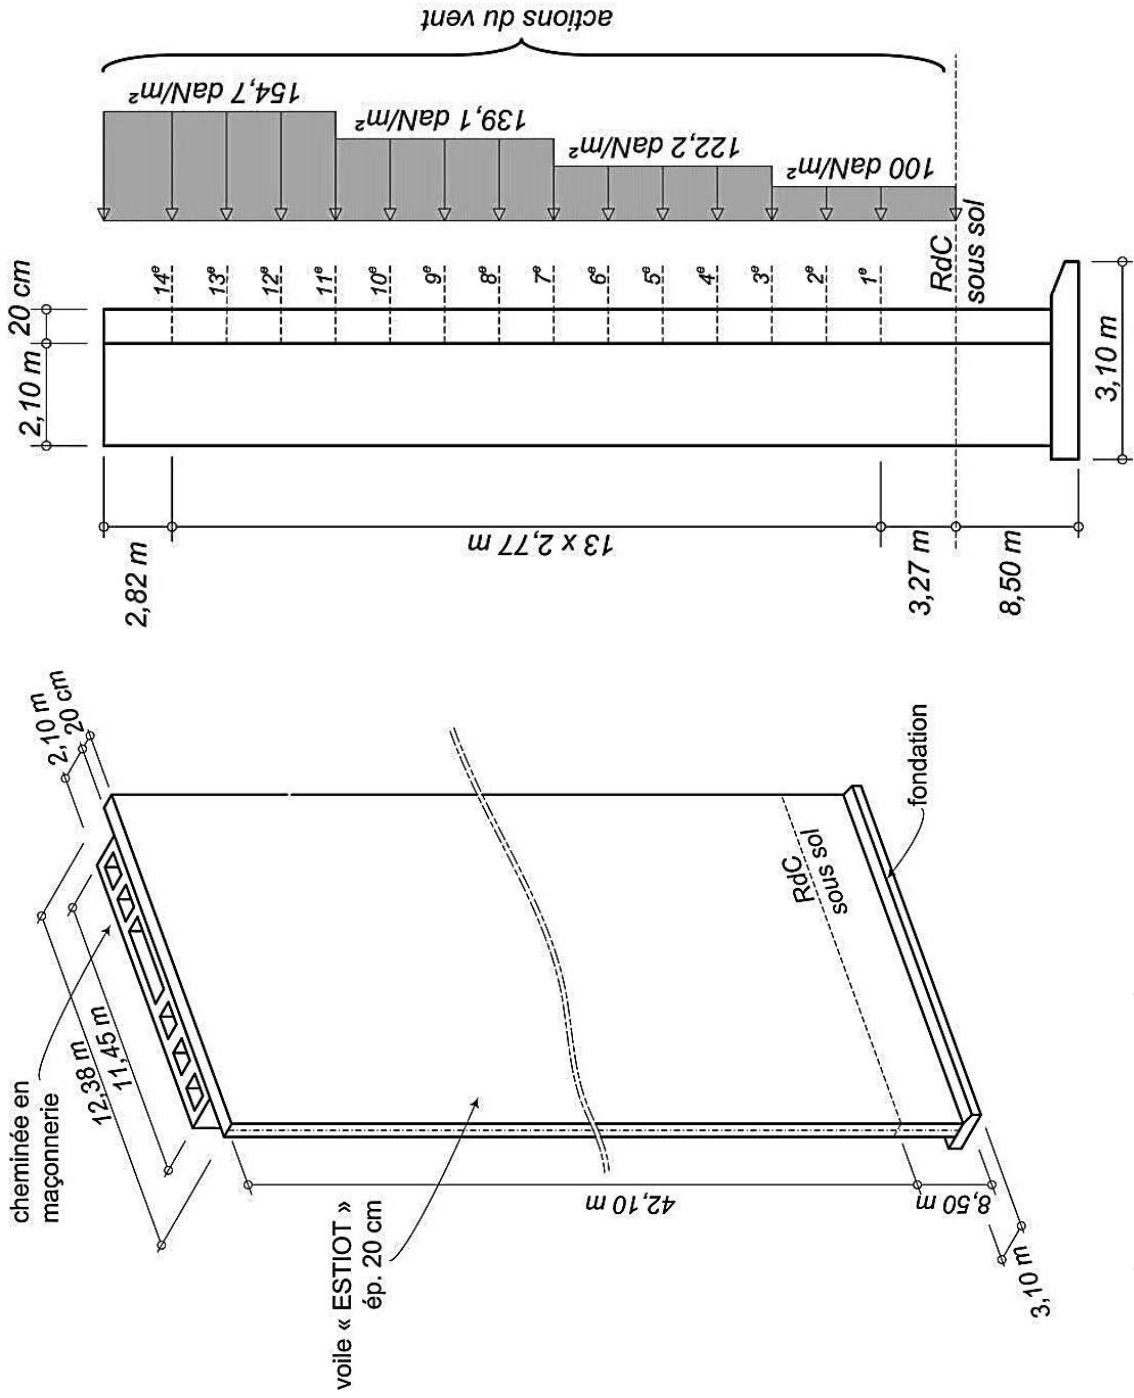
dimensions {cheminée+voile pignon+semelle}
